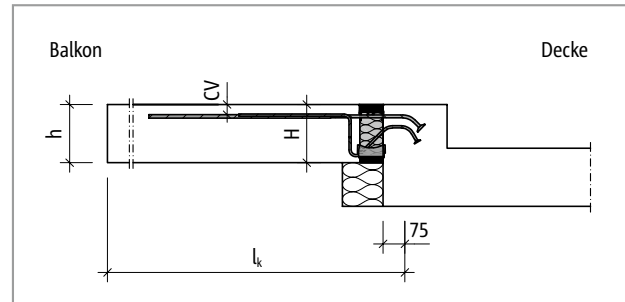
Schöck Isokorb® T Typ K-O: Statisches System
